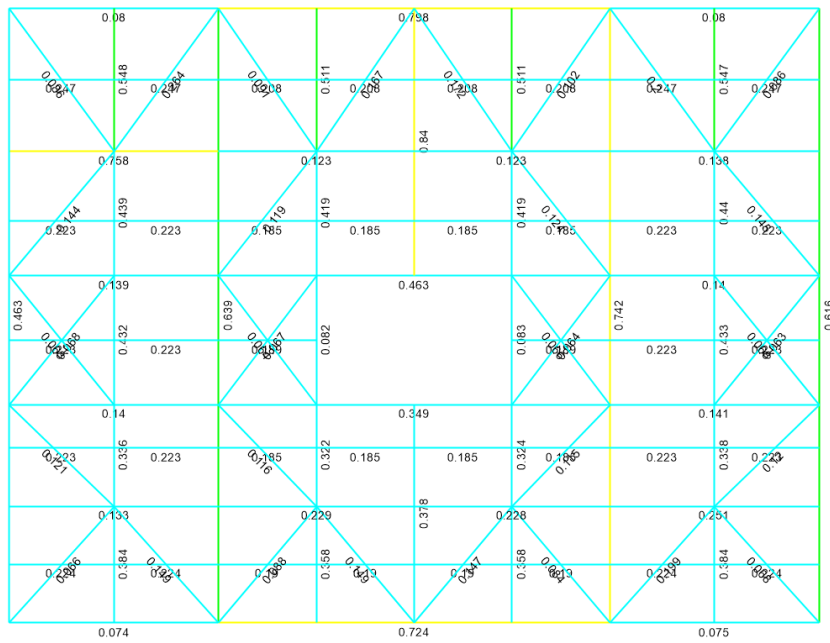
Factores de utilización planta primer nivel para cargas de diseño LRFD.
